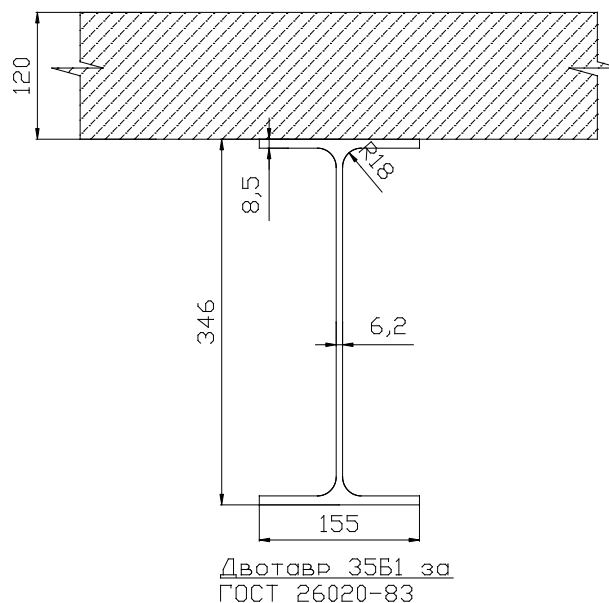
Схема конструкції, що складається зі сталеві балки, на яку опирається бетонна плита перекриття
